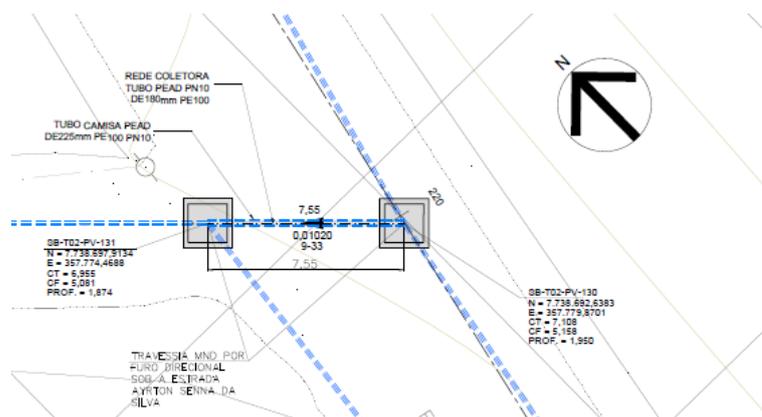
Planta de localização da travessia SB-T02 - PV-130 ao PV-131
